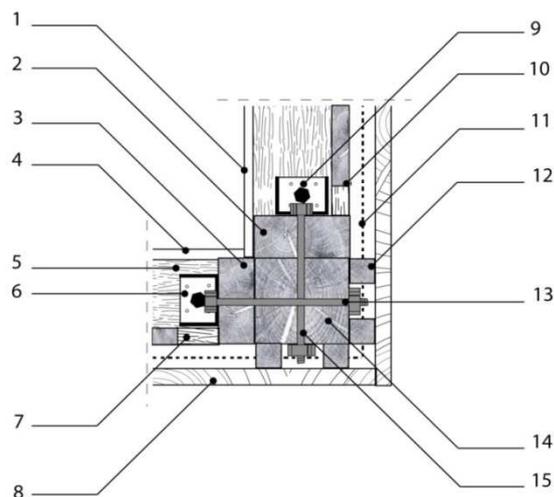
Coupe de principe d'assemblage d'angle de panneaux de contreventement de type PST
